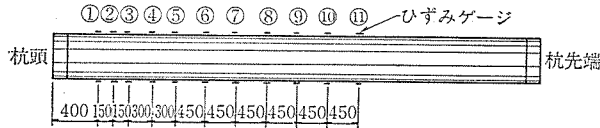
ひずみゲージ貼付位置 (対称位置 11点×2通り, 単位: mm)
